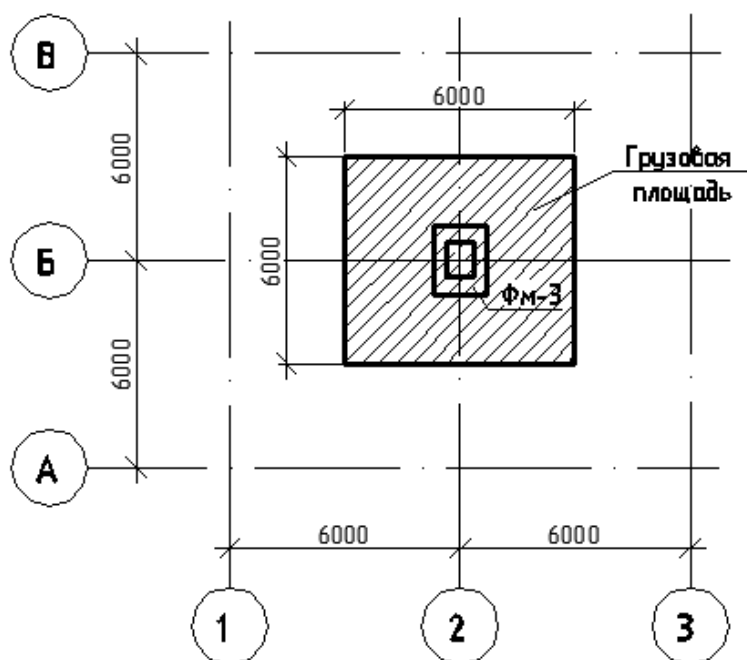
Грузовая площадь фундамента ФМ-3
